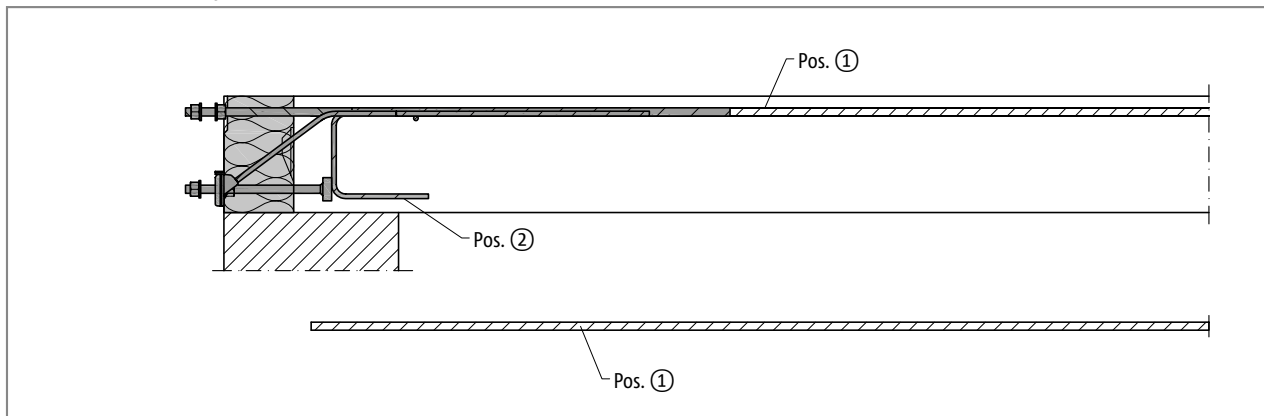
Schöck Isokorb® Typ KSXT14: Bauseitige Bewehrung, Schnitt
